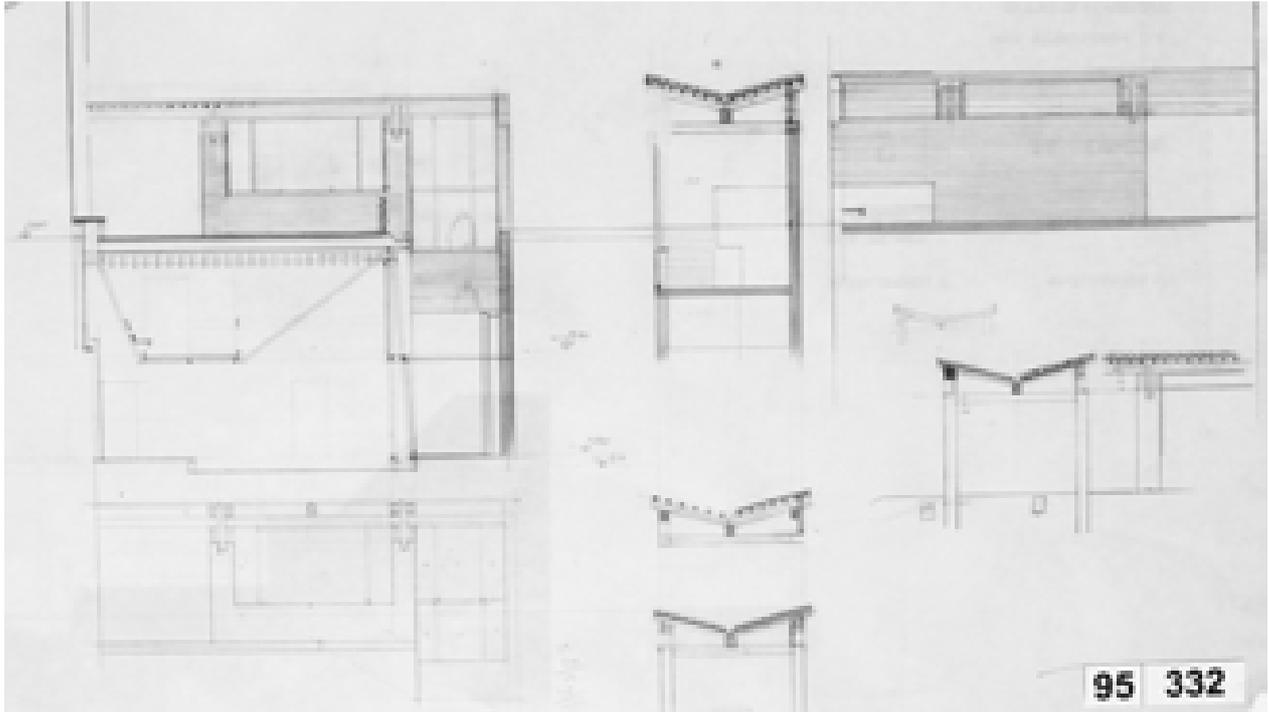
Studio sezioni e prospetti esecutivi – progetto del 1980 (AABS-95.332)
